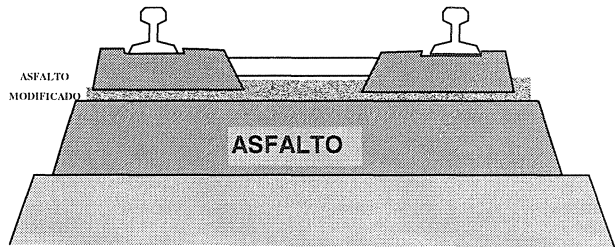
Sistema alemán. Traviesas de dos bloques y cordón de asfalto modificado con polímeros.
